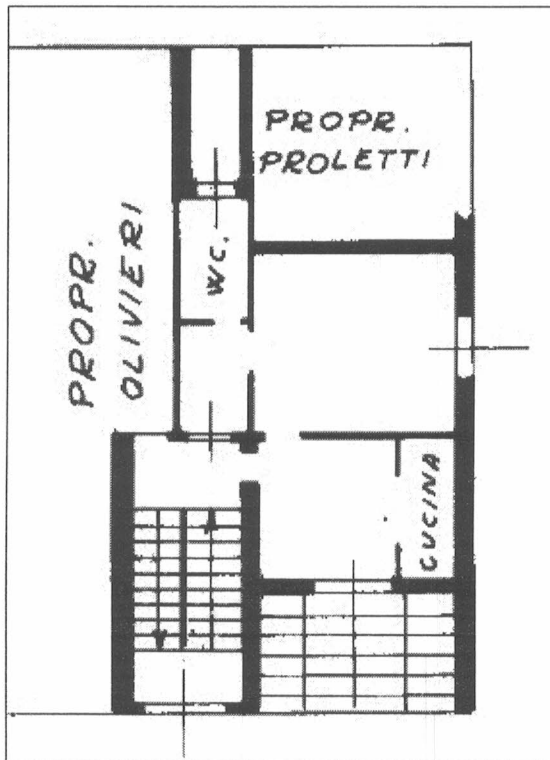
Planimetria catastale presentata il 8.06.1963
